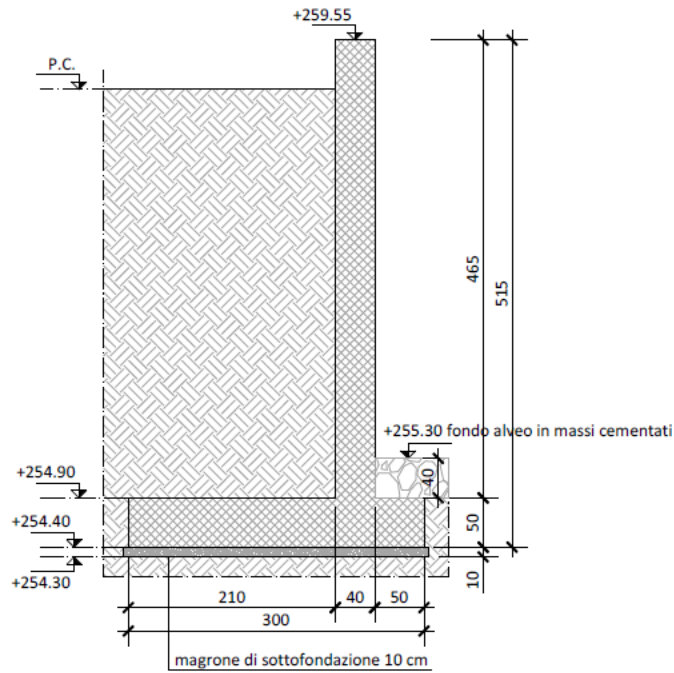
Sezione tipologica carpenterie muri d'ala.
